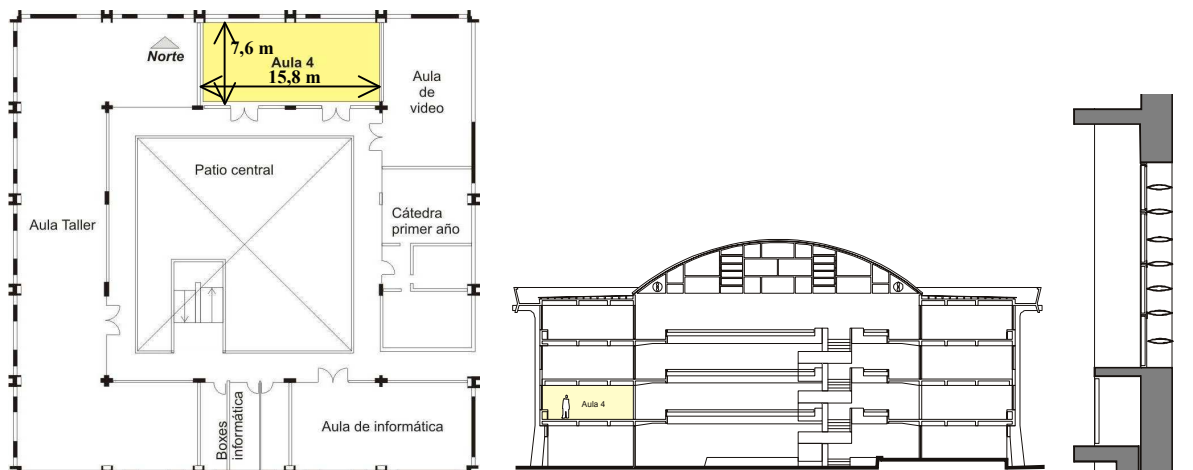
Planta general del primer piso FAU-UNT. Corte del block y corte del Aula 4
